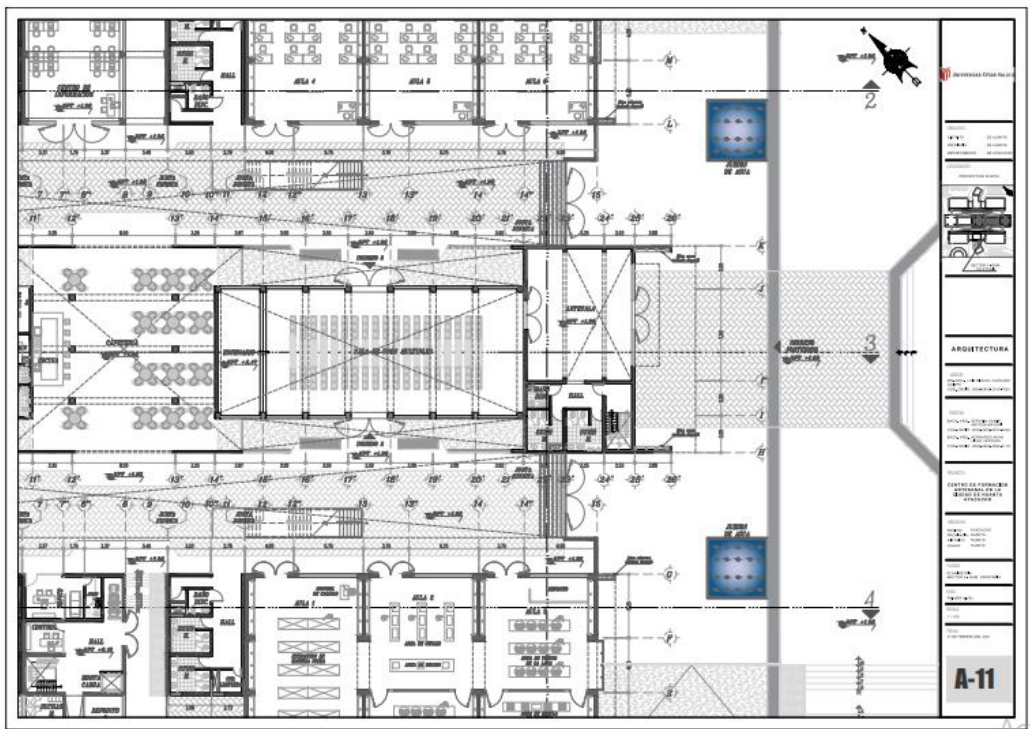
Planimetría del sector 2 ubicado en el piso 1. Escala 1/100.
